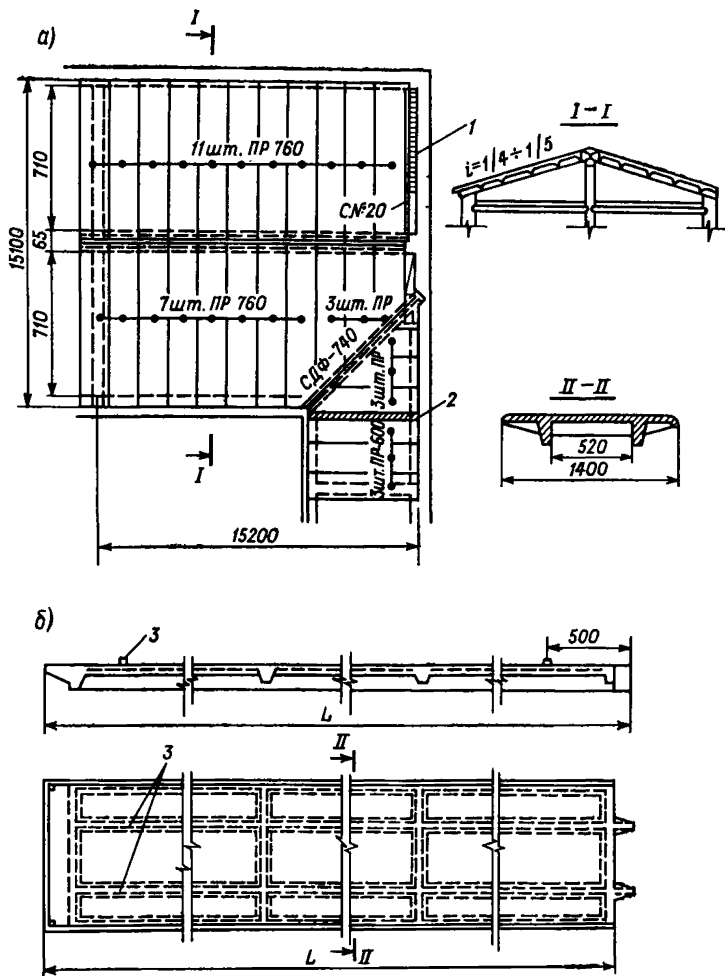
Сборная крыша из предварительно напряженных железобетонных панелей ПР конструкции ЛНИИ АКХ
